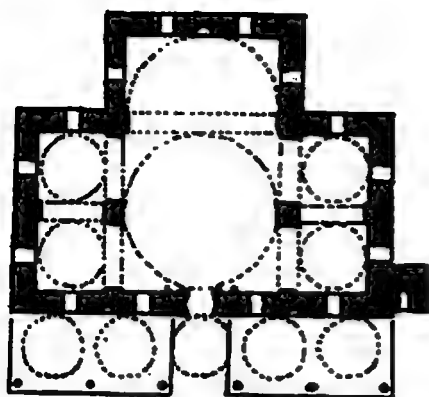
للمسقط الأفقي لجامع روم محمد باشا في إسكودار — إستانبول .
